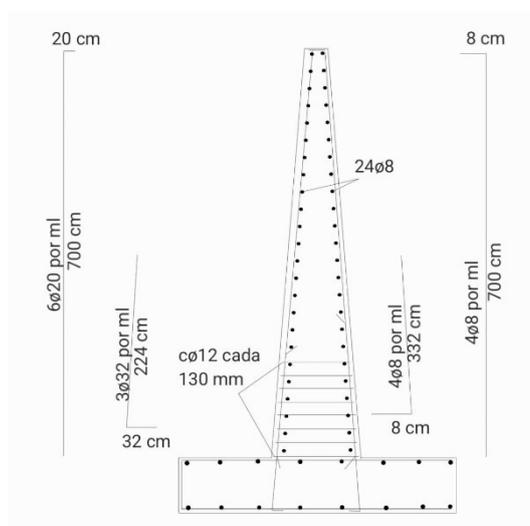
Disposición del armado para un muro de siete metros y canto variable (Fuente propia)
